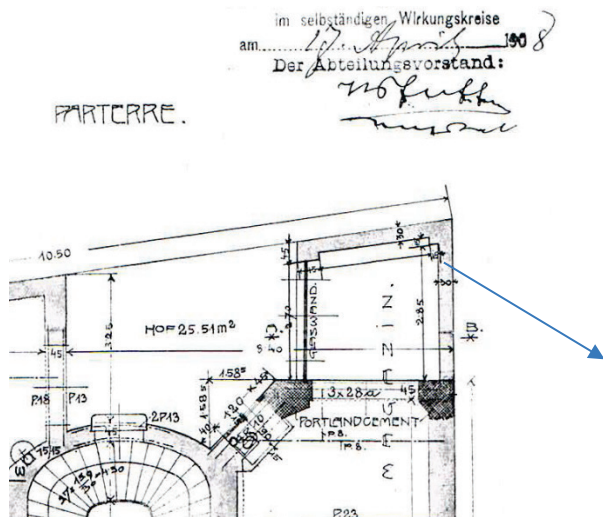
Planausschnitt Original-Einreichplan Parisergasse, Baujahr 1908
